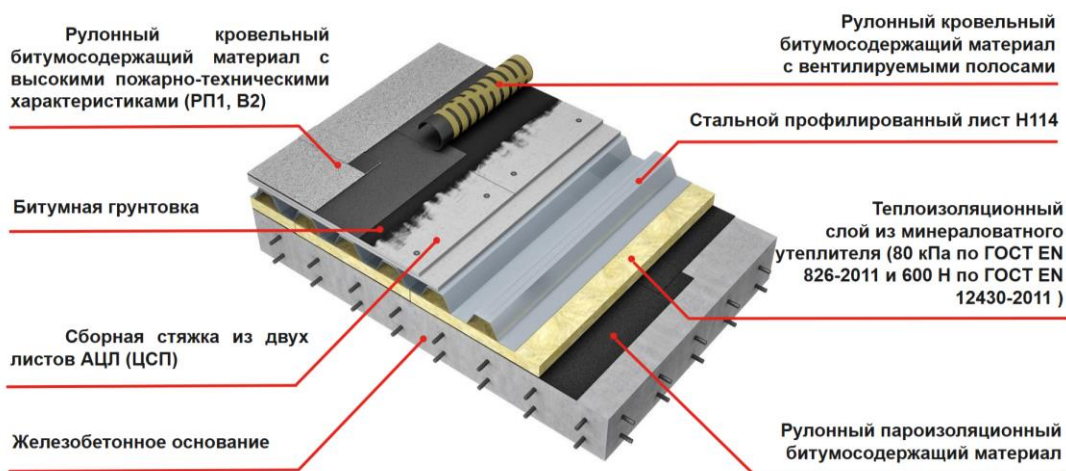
Схема укладки слоев совмещенной вентилируемой крыши
